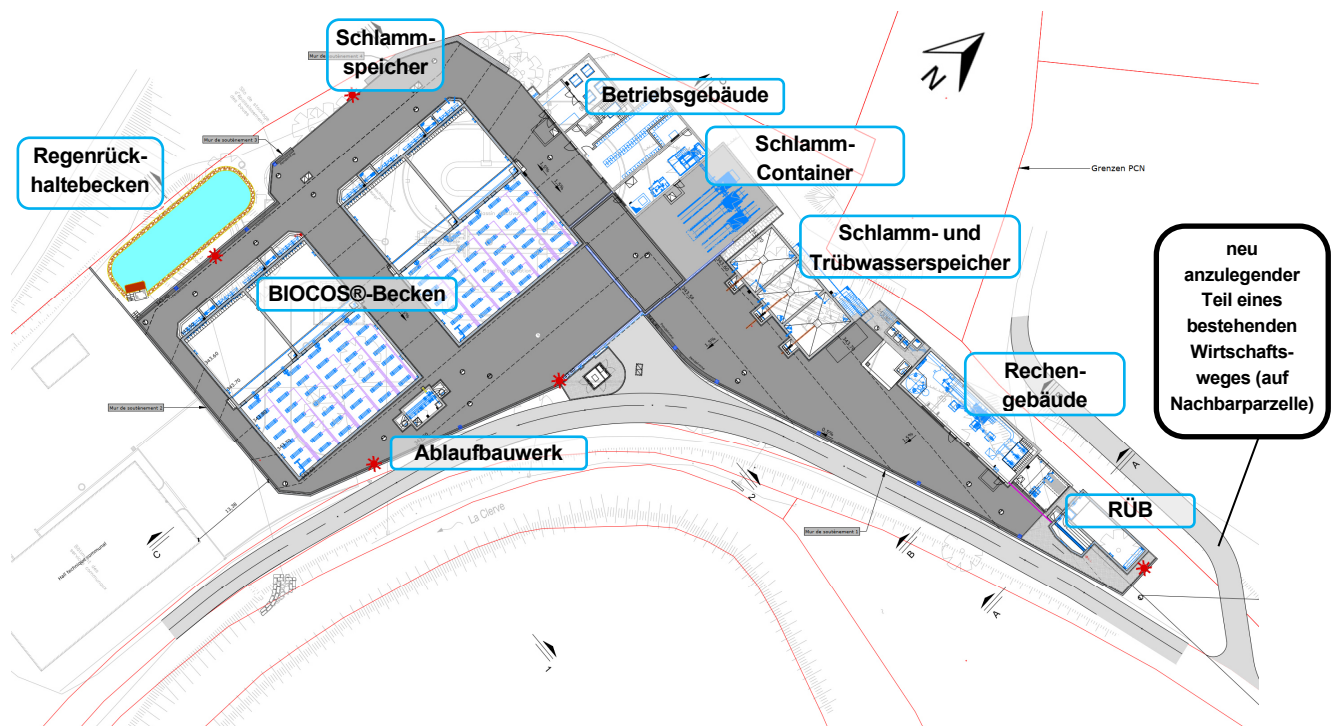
Ausschnitt Lageplan - Anordnung der Bauwerke der Kläranlage
